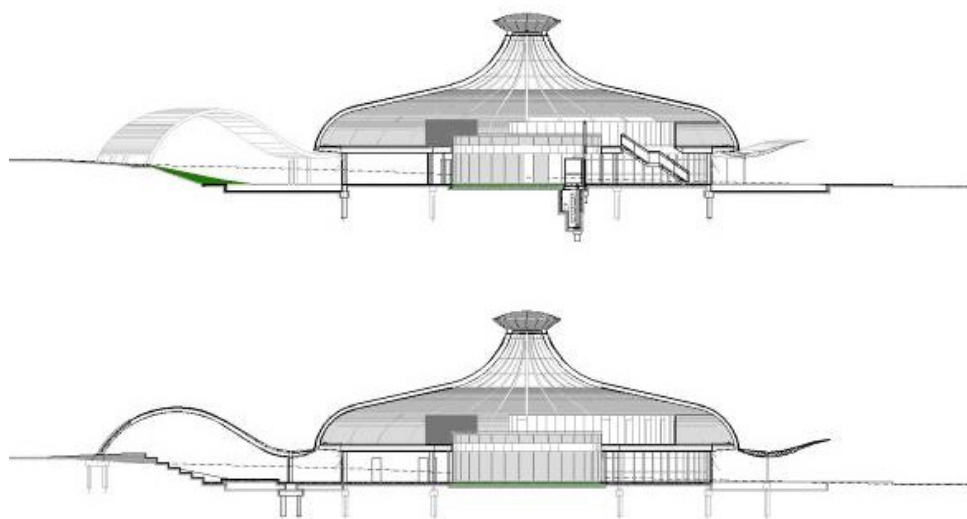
e 15 – Fachadas lateral e principal do prédio
